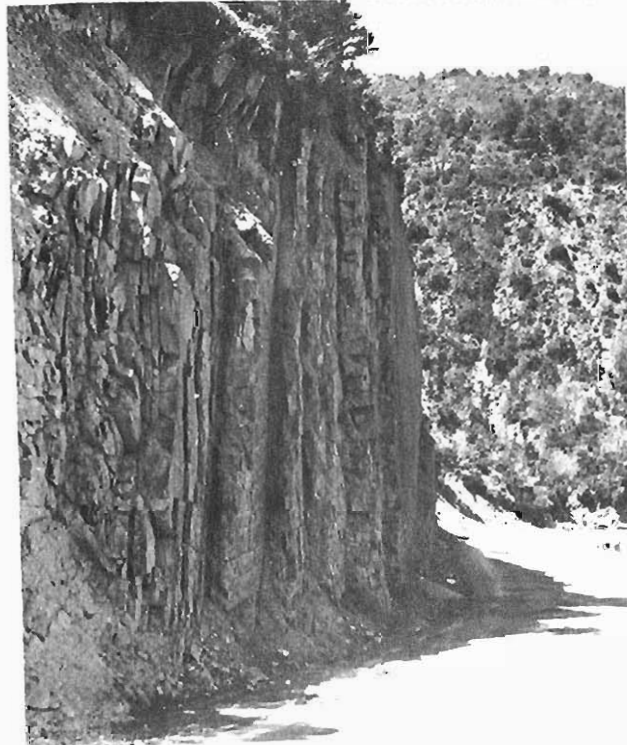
Talud artificial excavado en bancos verticales de areniscas oligocenas (Carretera nacional 240 de Huesca—Pamplona).
